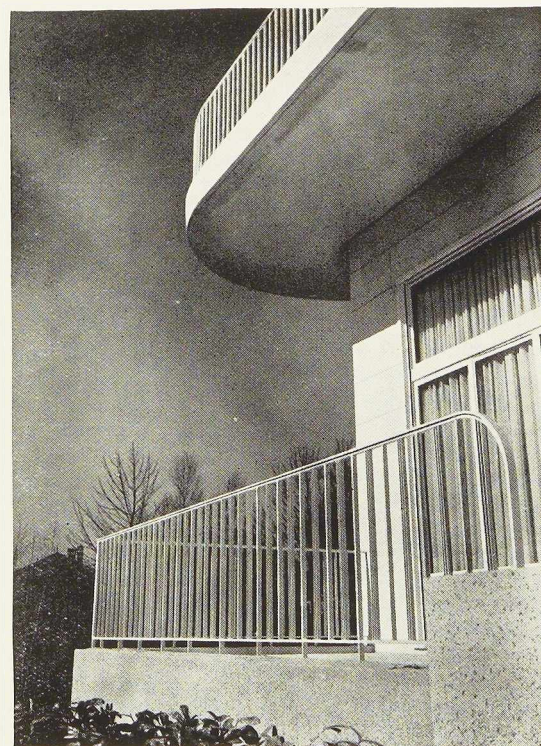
Détail des balcons et garde-corps. Ceux-ci ont été entièrement exécutés sur place, par soudure.
